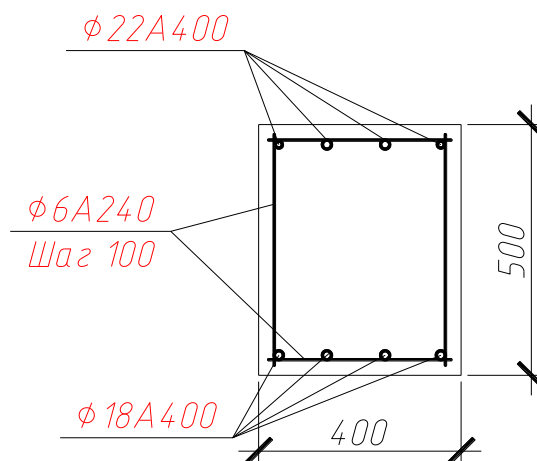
Схема армирования второстепенной балки перекрытия
